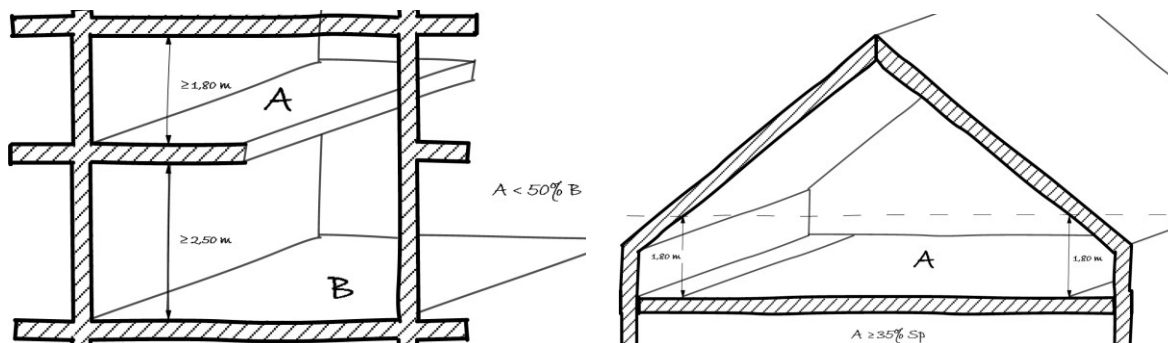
Hauteur libre sous plafond en cas d'une mezzanine ou de combles
